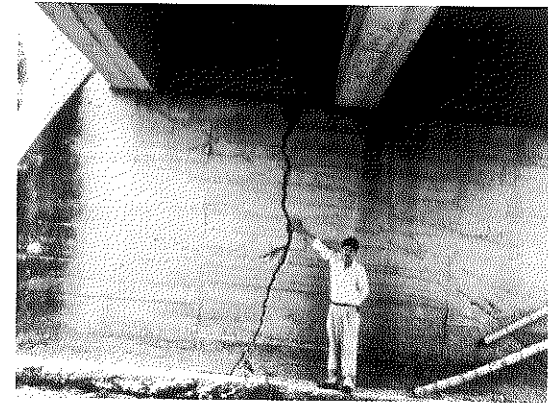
Grieta en estribo por socavación de la cimentación superficial y la falta de capacidad de carga
